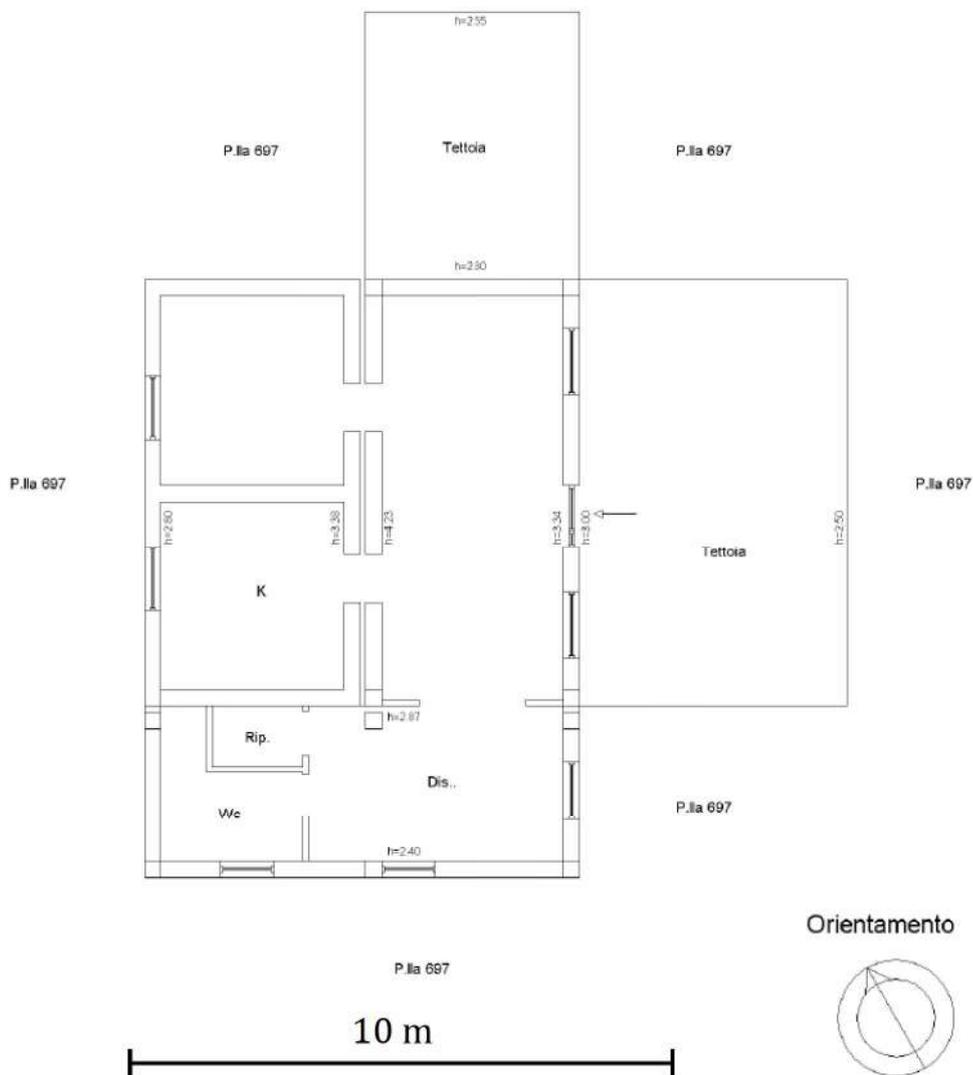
Estratto Planimetria Catastale – Civile abitazione Foglio ■ Part. ■ sub ■ - Piano terra (appartamento, ex deposito Foglio ■ Patt. ■)
